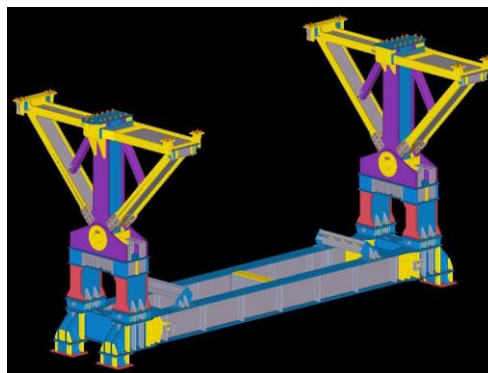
35 – Modelo 3D do pórtico de betonagem
